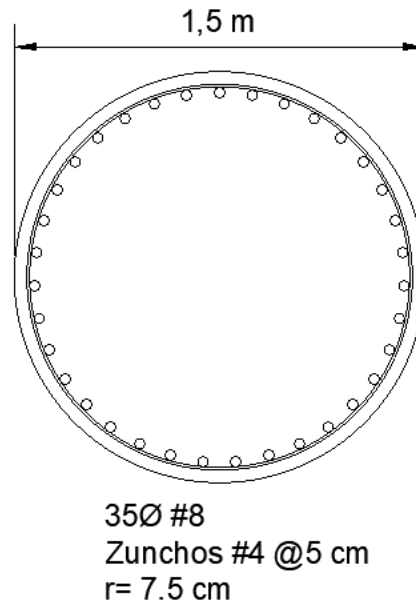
Detalle de refuerzo de columna con aislamiento sísmico
